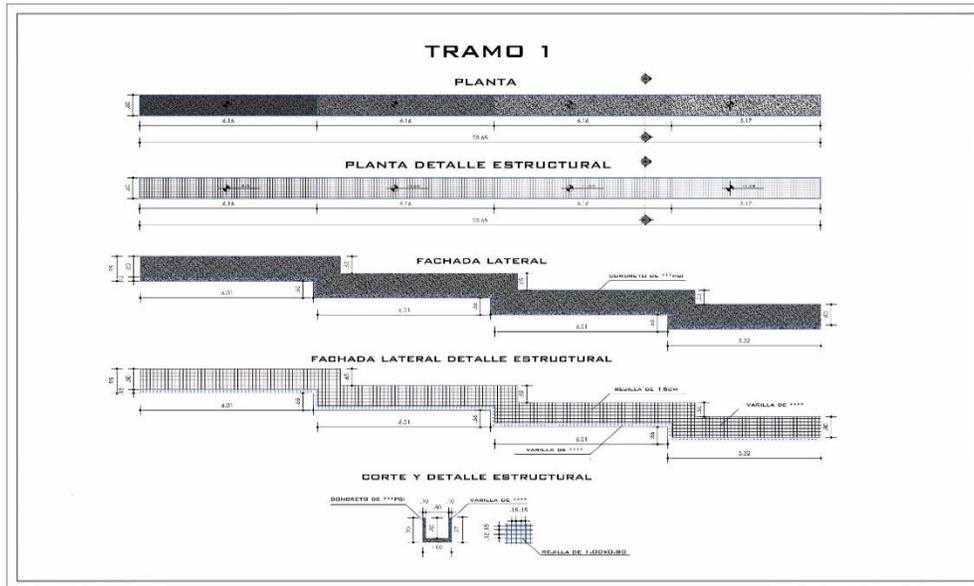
Plano tramo 1 perfil longitudinal, planta y detalle estructural.
